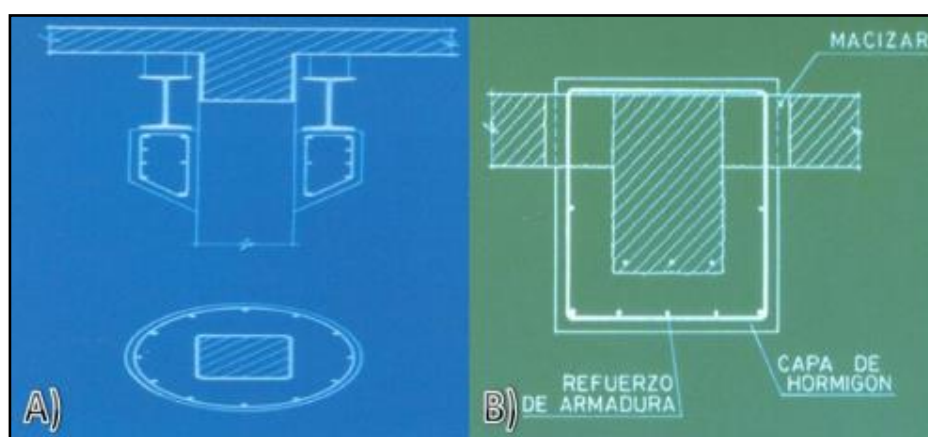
A) Zuncho de un pilar; B) Refuerzo de hormigón en viga que se puede incorporar armadura. Fuente: Rincón Puigvert J. (2014).
